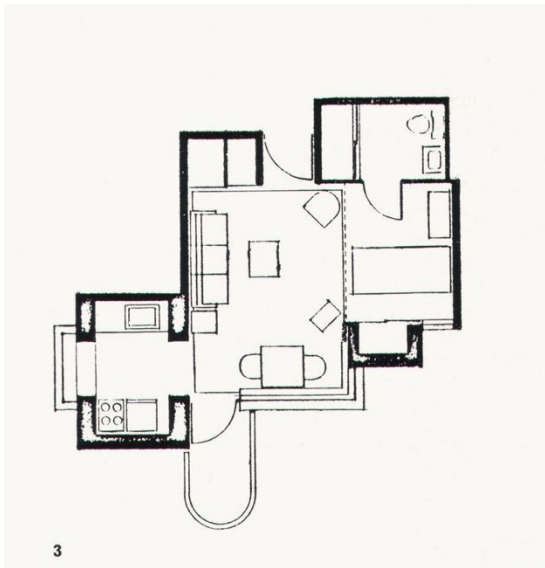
Paul Rudolph, Crawford Manor, Grundriss Einzelapartment, 1966, New Haven.
